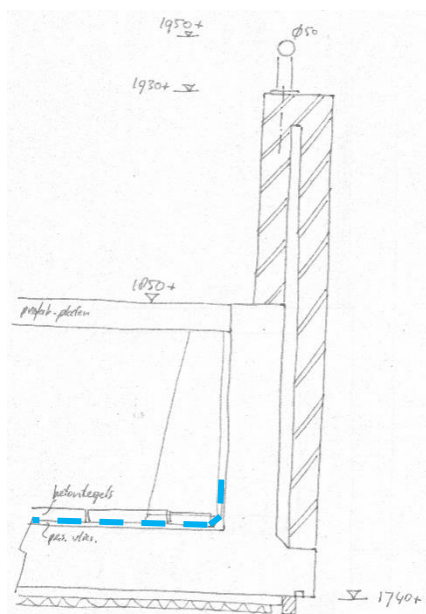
Openingen zijn gelaten tussen het gebouw, de betonvloer van de nissen van de entrees en de hemelwaterafvoer. Hierdoor kan water naar de kruipruimte lopen.
